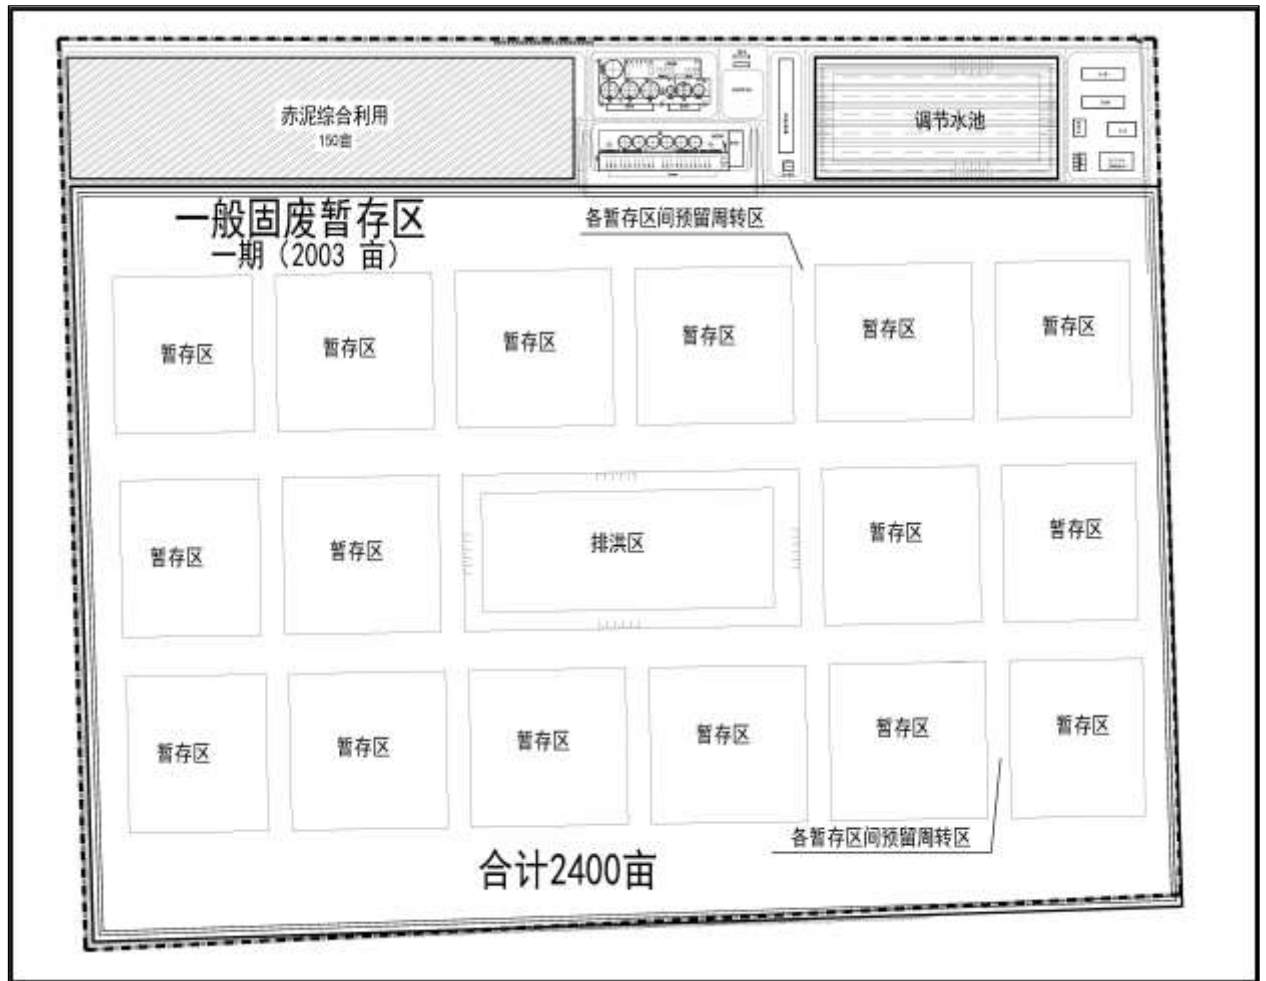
项目一般工业固体废物处置场暂存区分区方案及平面布置图
